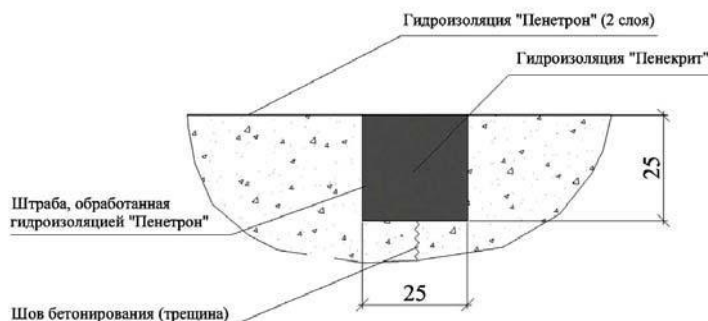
Ремонт швов бетонирования трещин
